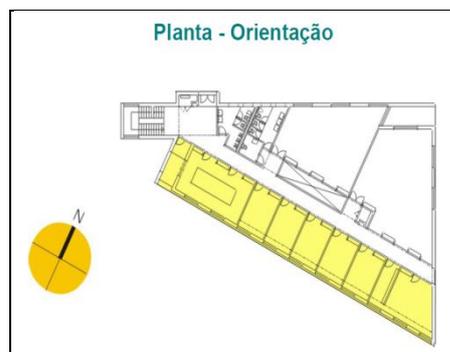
Planta com orientação das fachadas (IEFP, 2012)
